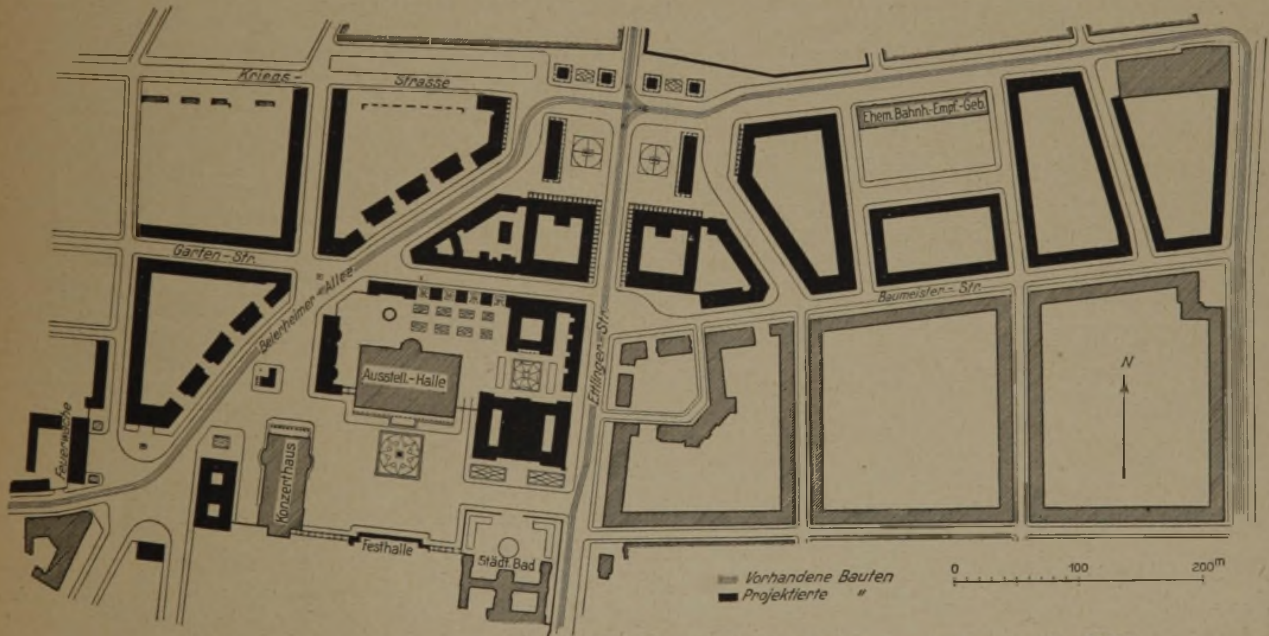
Lageplan des Ettlertorplatzes mit den vorhandenen und geplanten Bauten. (1 : 6000.)
